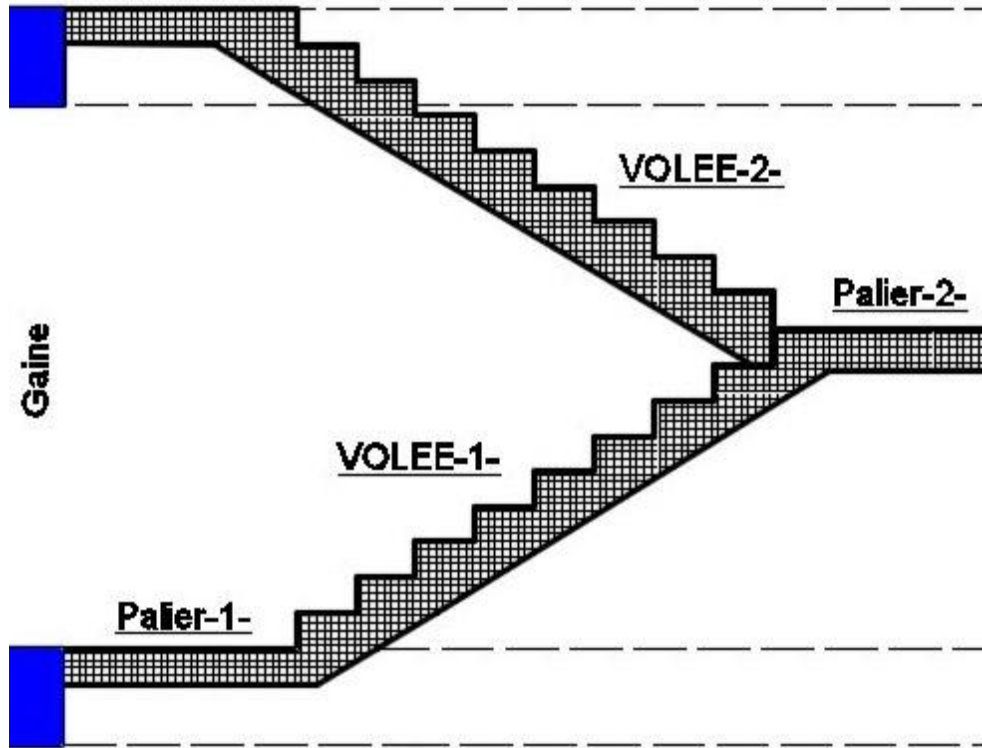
coupe transversale de cage d'escalier.
